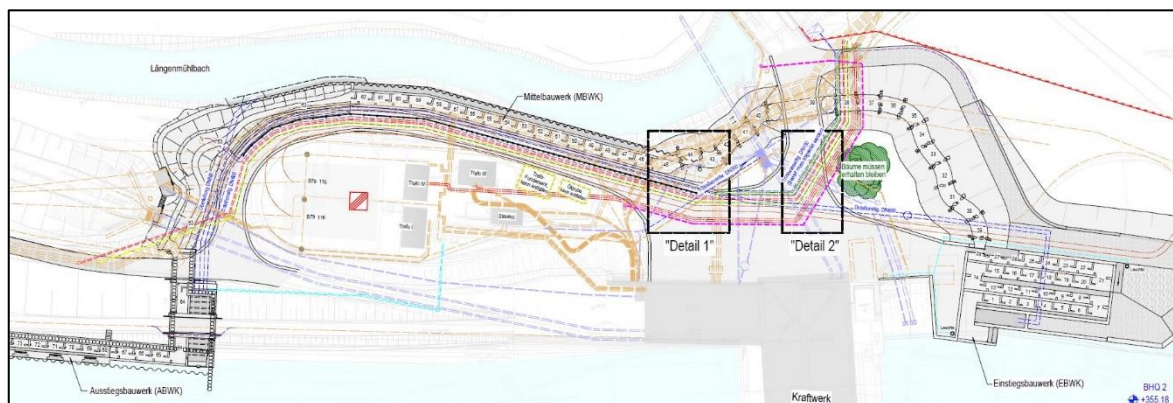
Übersichtslageplan betroffener Sparten und deren geplante Verlegung
